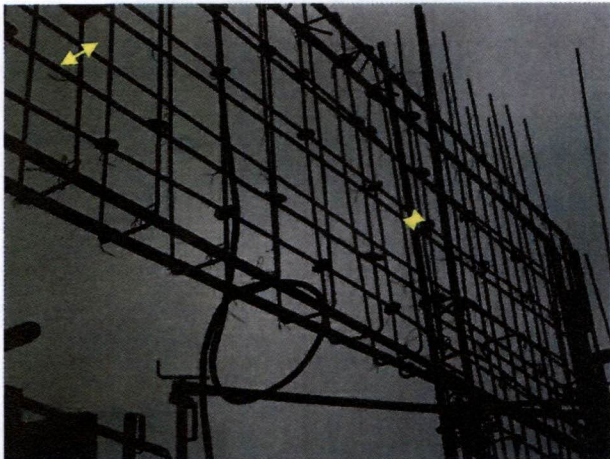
, de 14 de mayo de 2014: Pilar en eje 13, de la elevación O, de la Lam. Elevación ejes O y R del plano de estructura CL N°3785-107, de junio de 2012, que identifica el doblaje insuficiente de las armaduras.
